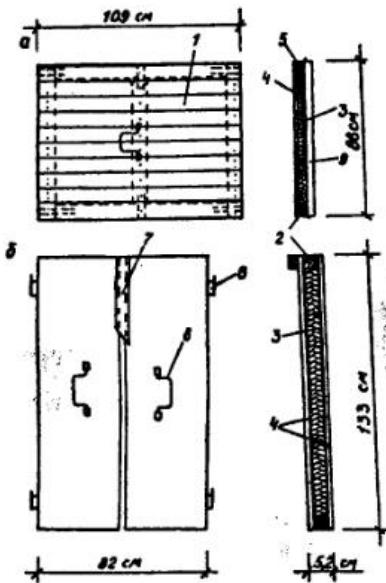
Крышки люков: а — погреба; б — мансардной лестницы и чердака. 1 — доски пола; 2 — бруски; 3 — минераловатные плиты или антисептированный войлок; 4 — водостойкая фанера или две весноволокнистая плита; 5 — пергамин; 6 — петли; 7 — нащельник; 8 — ручка; 9 — отделочная доска.
